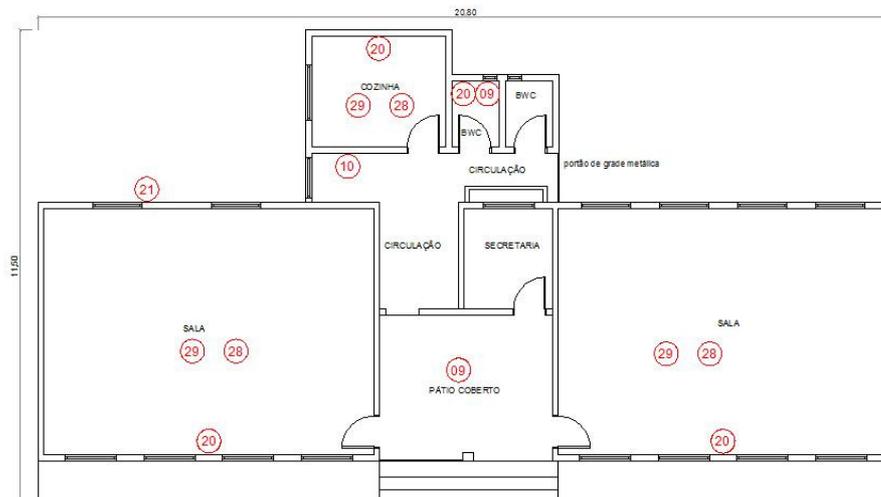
Planta Baixa creche Procópio Lima – Barracão
